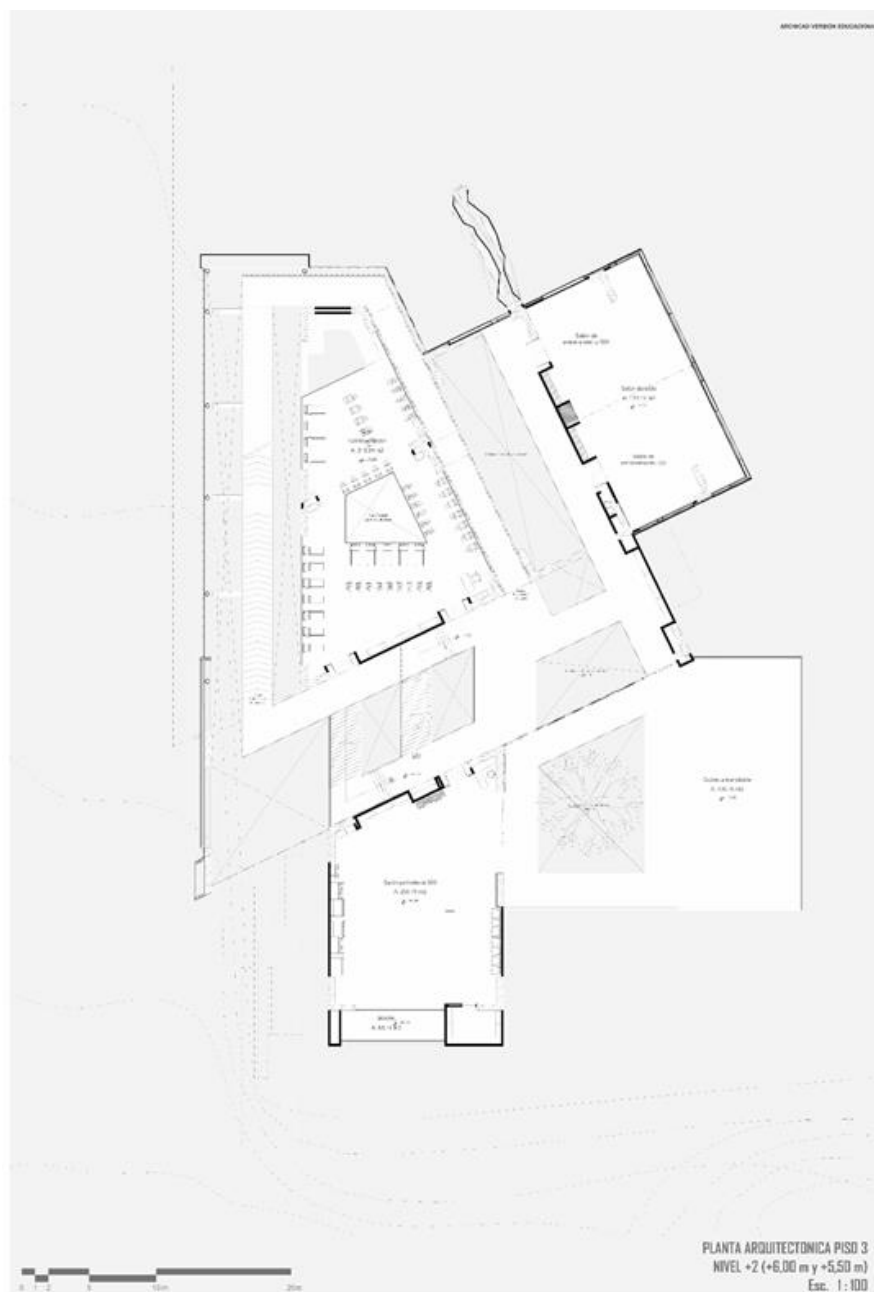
Planta piso 3. Nivel +2 (+6.00m)
